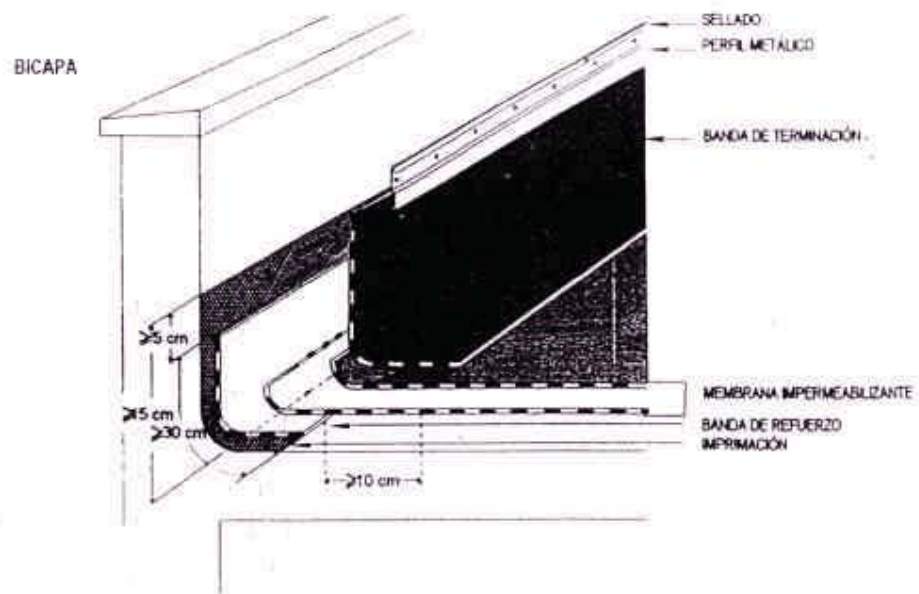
Remate con perfil metálico para membranas autoprotegidas
